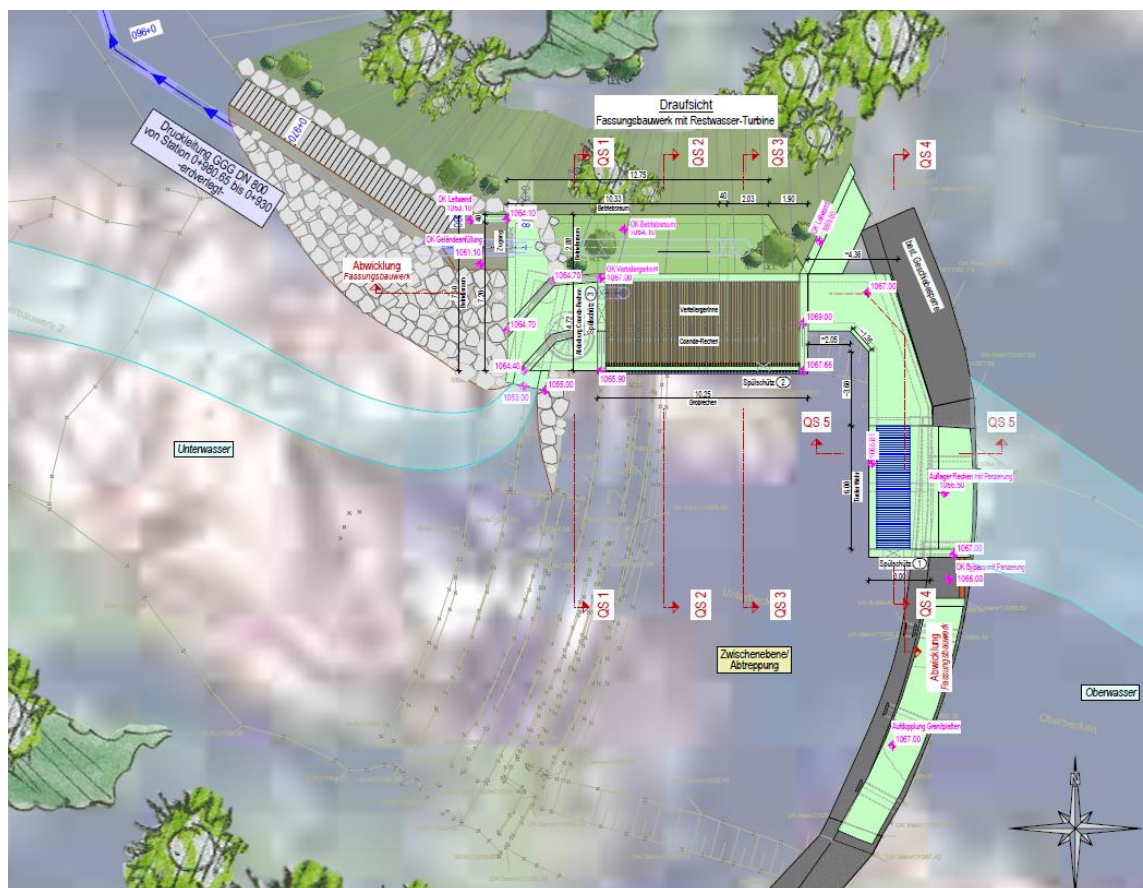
Draufsicht geplantes Fassungsbauwerk – Zulaufkanal („Obergeschoß“)
